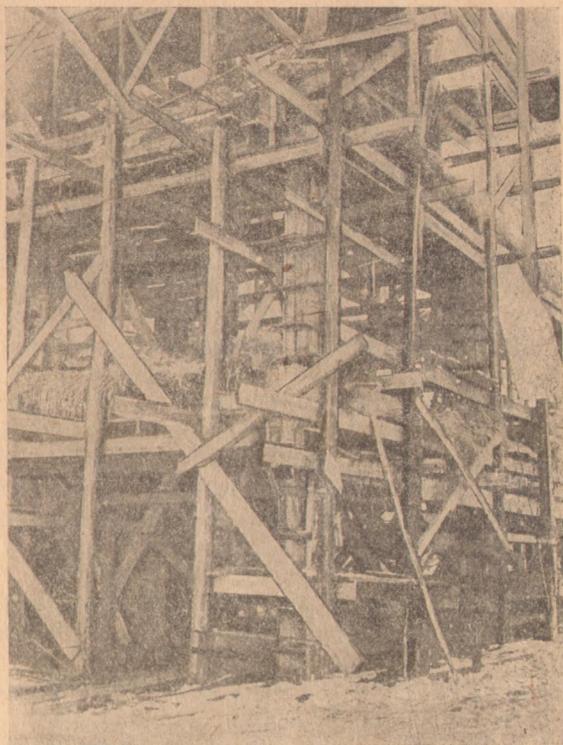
Угол склада земли литейного цеха. Железобетонные балки укрыты соломенными матами
